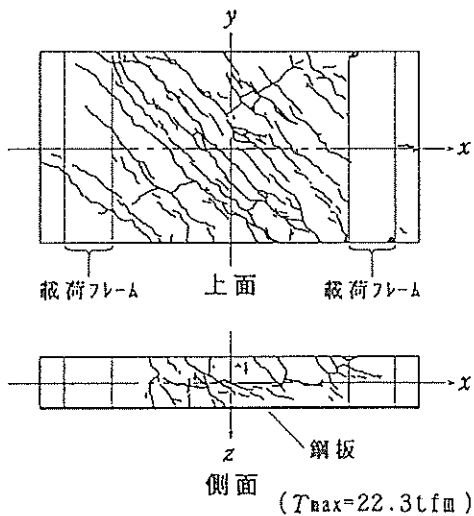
供試体 OS-22-100のひび割れ発生位置
